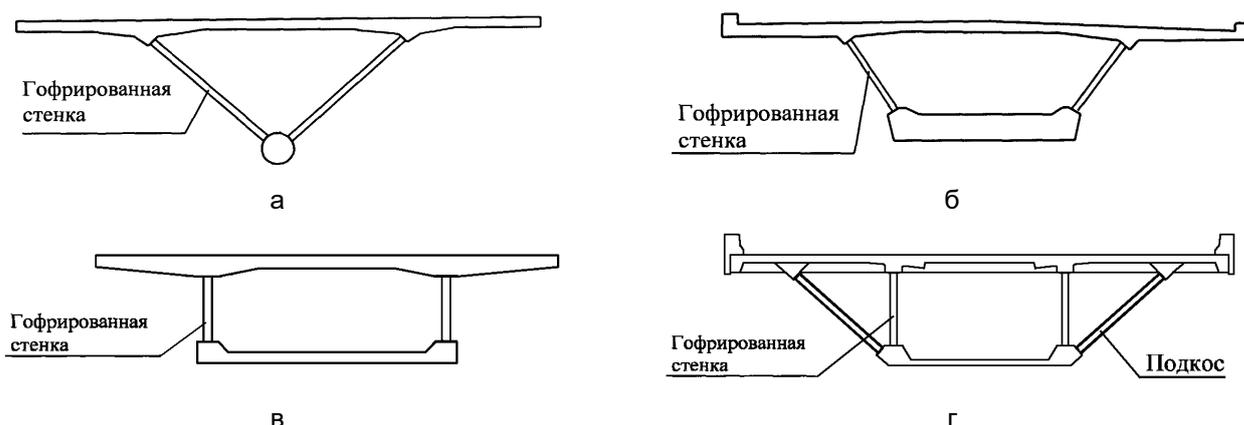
Типы коробчатых поперечных сечений сталежелезобетонных мостов:
